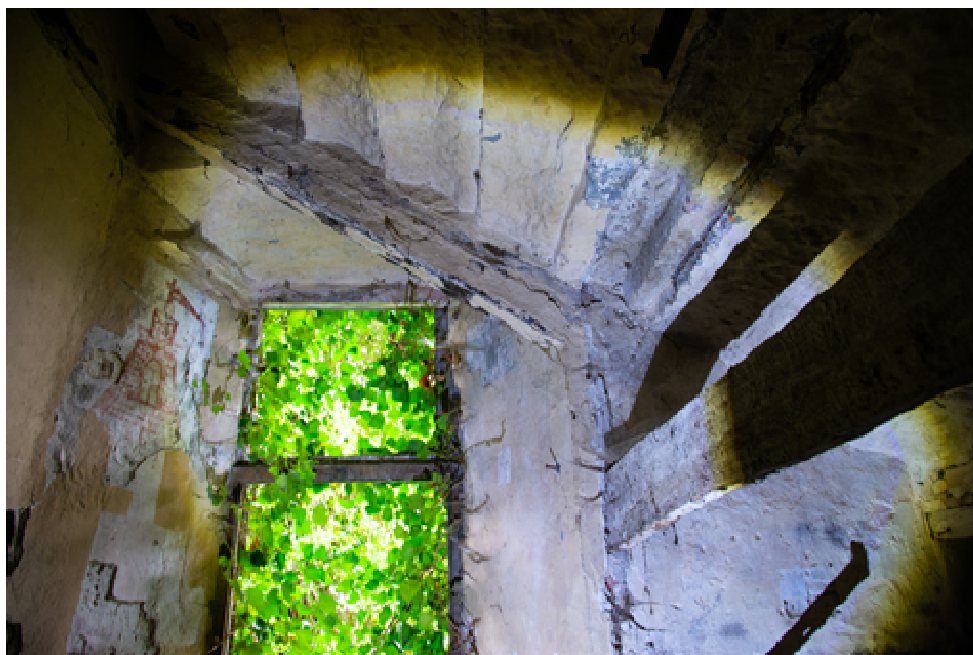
Degrado architettonico e strutturale, totale mancanza di infissi e vegetazione infestante al piano primo
